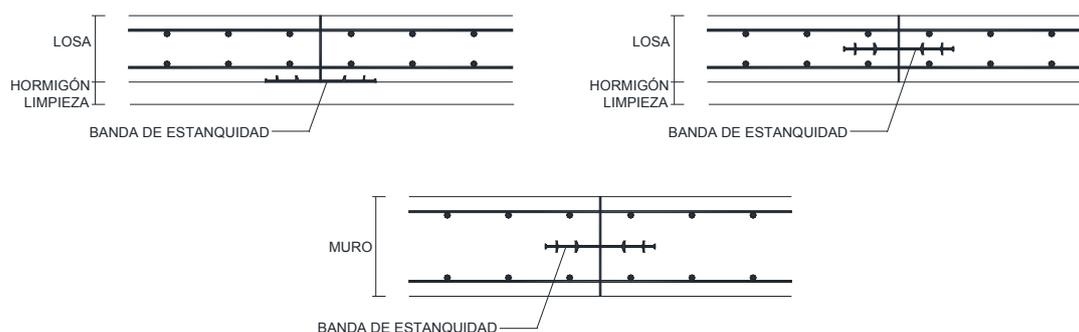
Detalle de junta de hormigonado en solera (arriba) y en muro (abajo)
